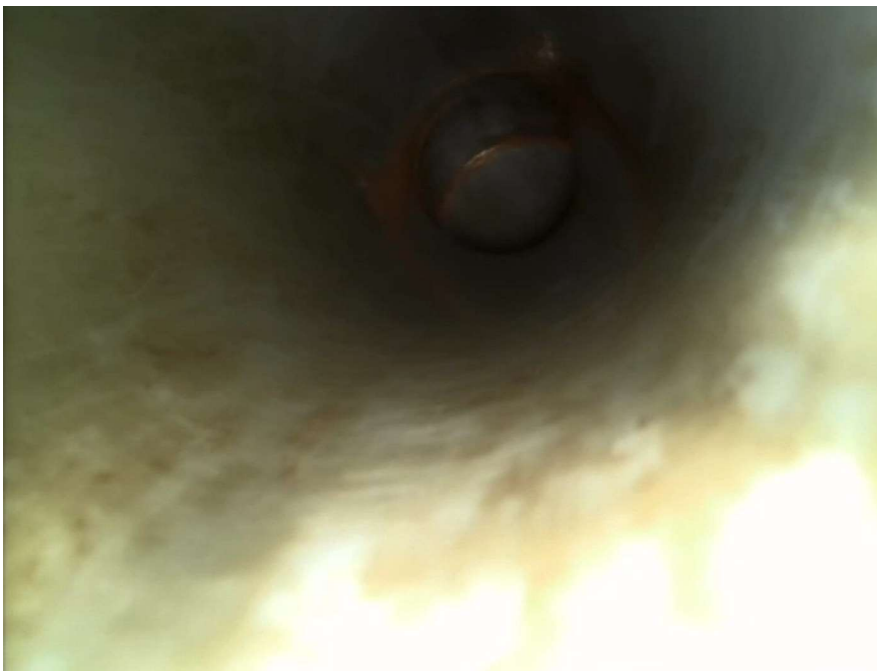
Stukje verder door in de rechter leiding van voorgaande foto
